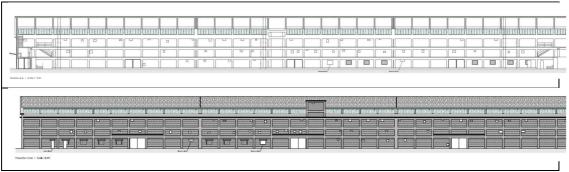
Fabbricato C10, sezione e prospetto longitudinale
